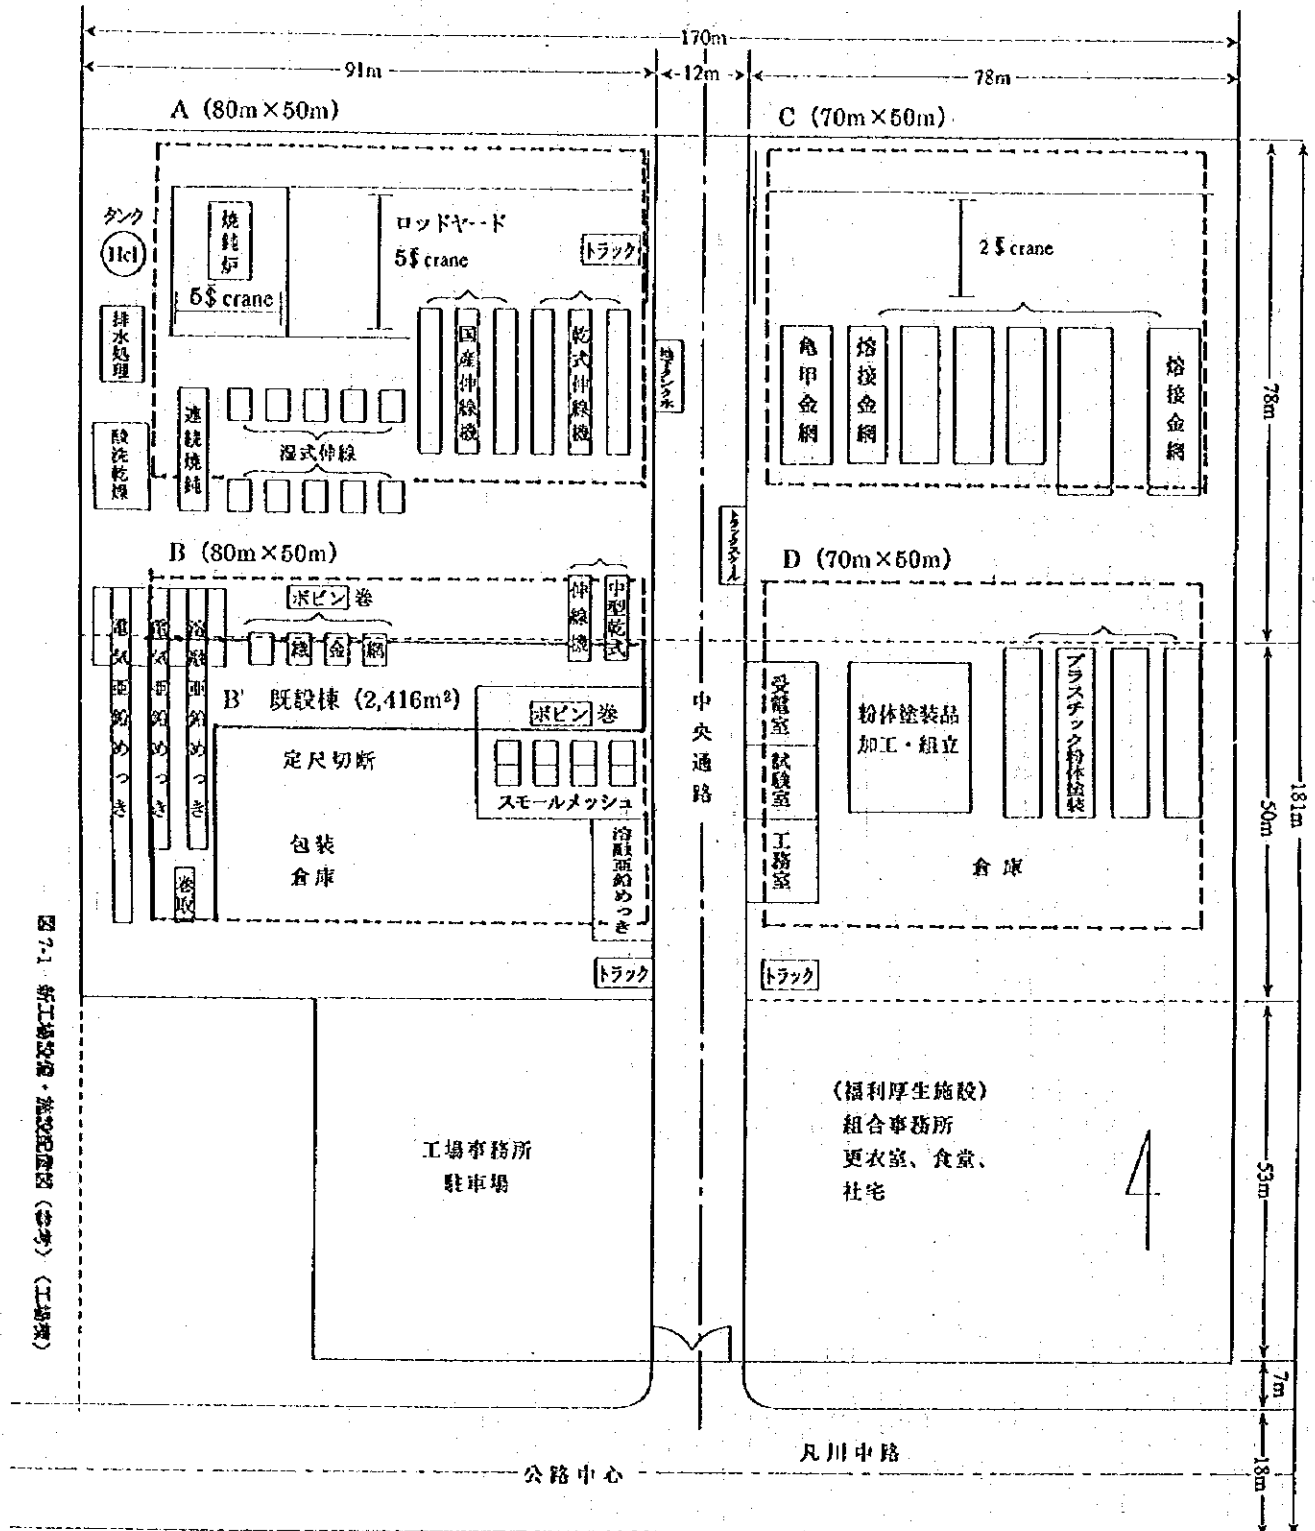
新工場設備・施設配置図 (参考) (工場棟)
